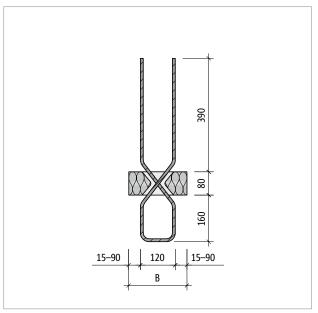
Schöck Sconnex® type W-N-VH: coupe A-A du produit
